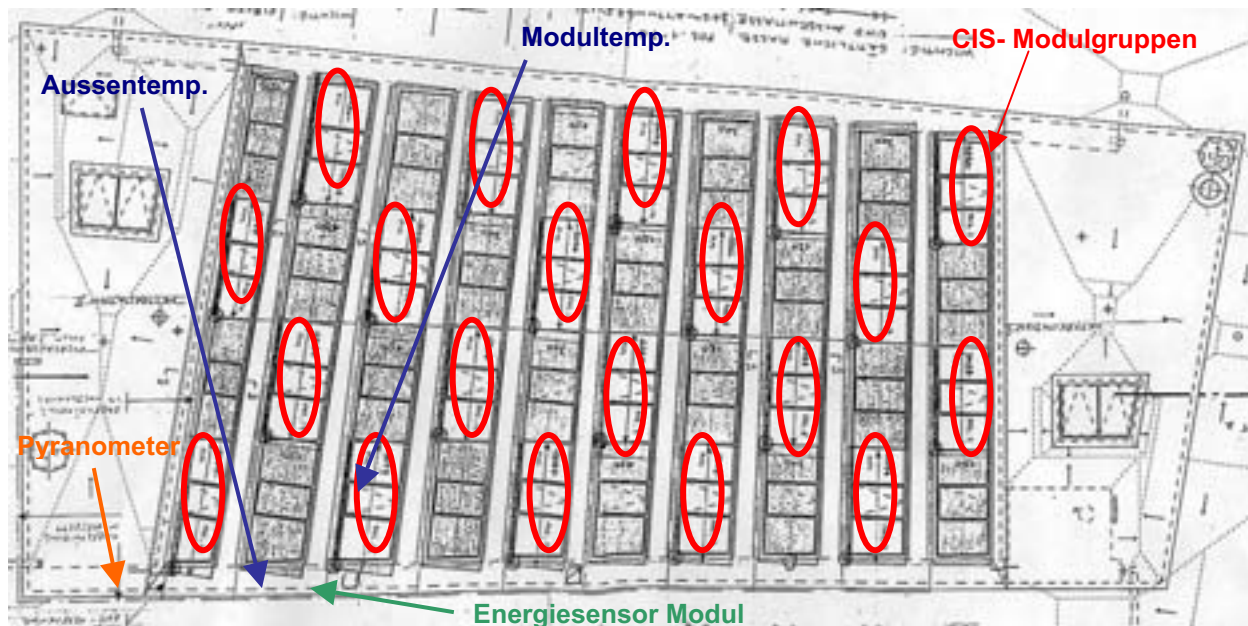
Dachaufsicht mit Kennzeichnung der Modulgruppen und Messaufnehmer
